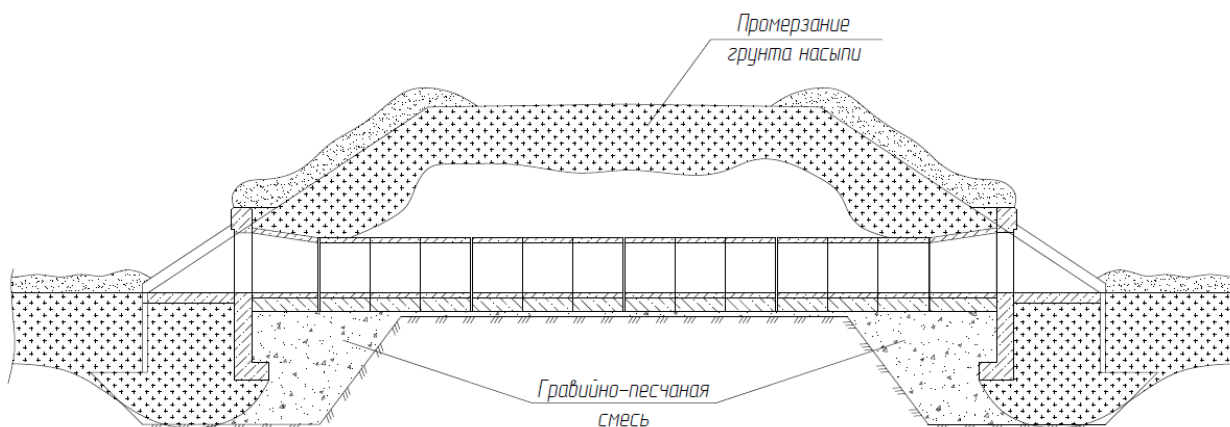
Изополя промерзания грунта в типичной конструкции железобетонной водопропускной трубы под насыпями автомобильных и железных дорог.
